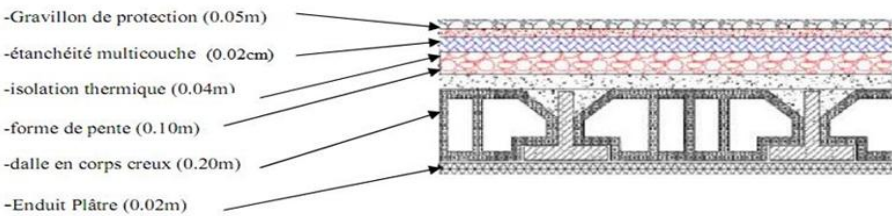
Schéma d’un plancher de terrasse inaccessible
